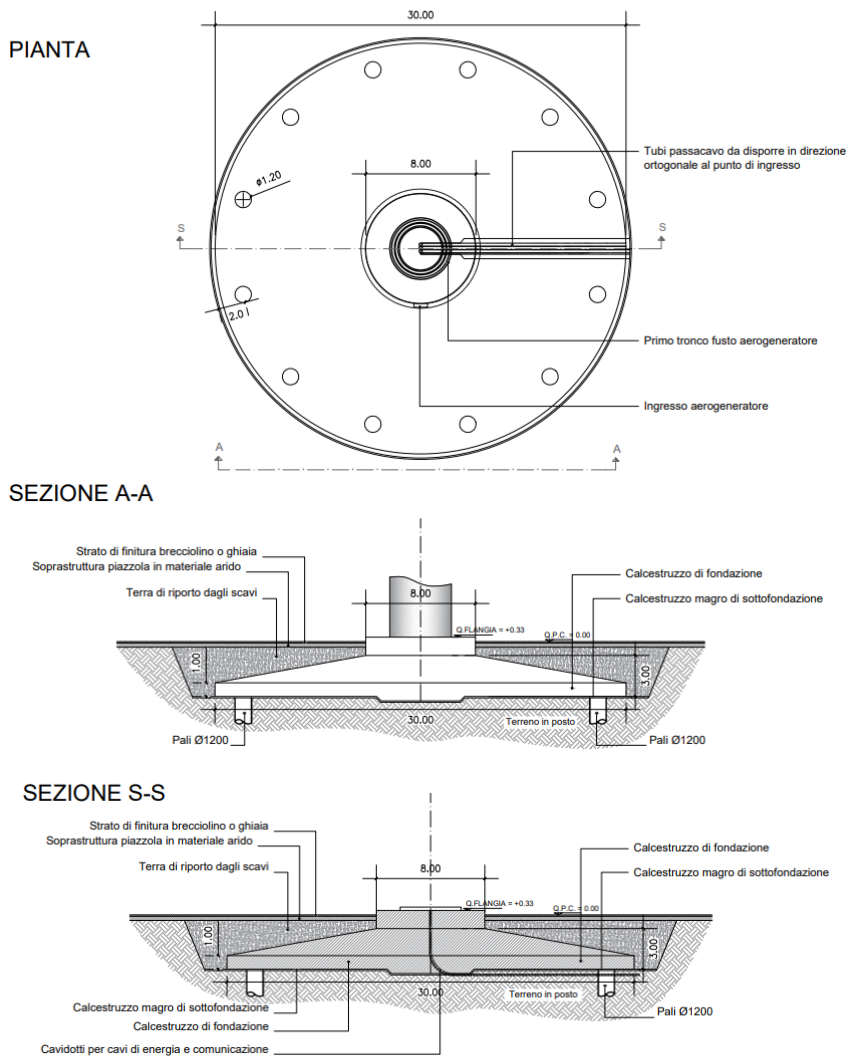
Pianta e vista della fondazione tipo dell'aerogeneratore V162.
